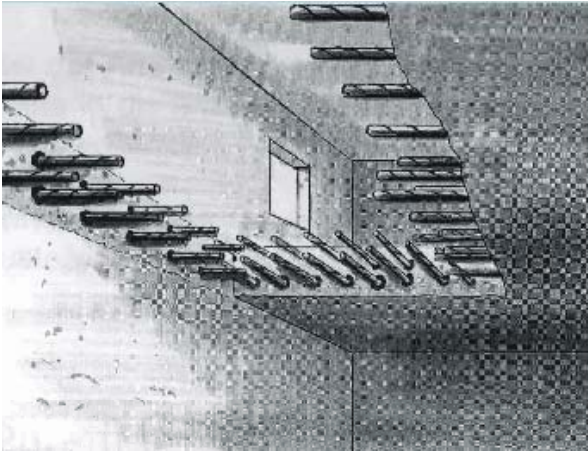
Bewehrungsanschlüsse in Neubauten
